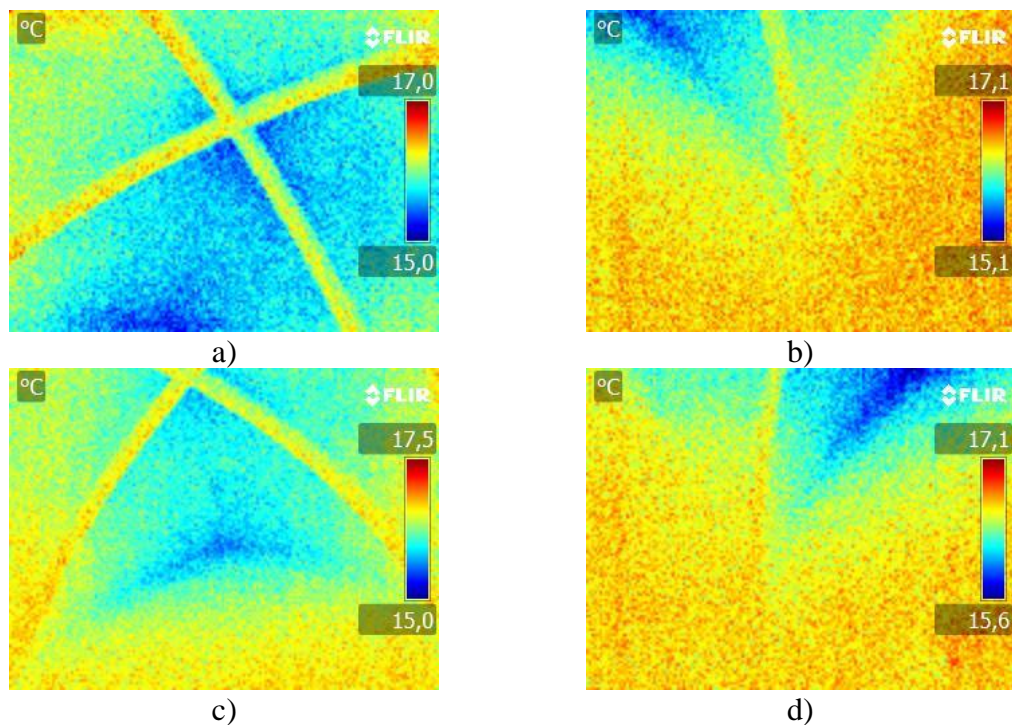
Termografía salas bajo cubierta 1, adyacente a la nave lateral: a) Vista general de cubierta, b) Conexión fachada con esquina lateral, c) Conexión fachada con cubierta, d) Conexión fachada con esquina lateral opuesta.
